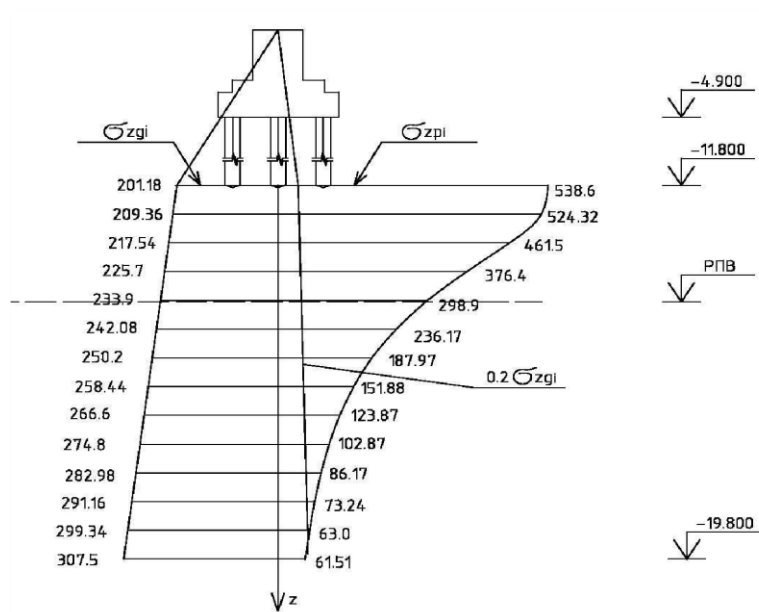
Схема до розрахунку просідання основи пальового фундаменту
